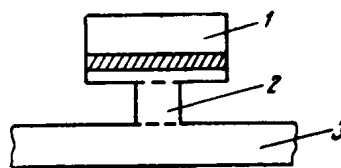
Схема приложения местной нагрузки для сложного сечения
